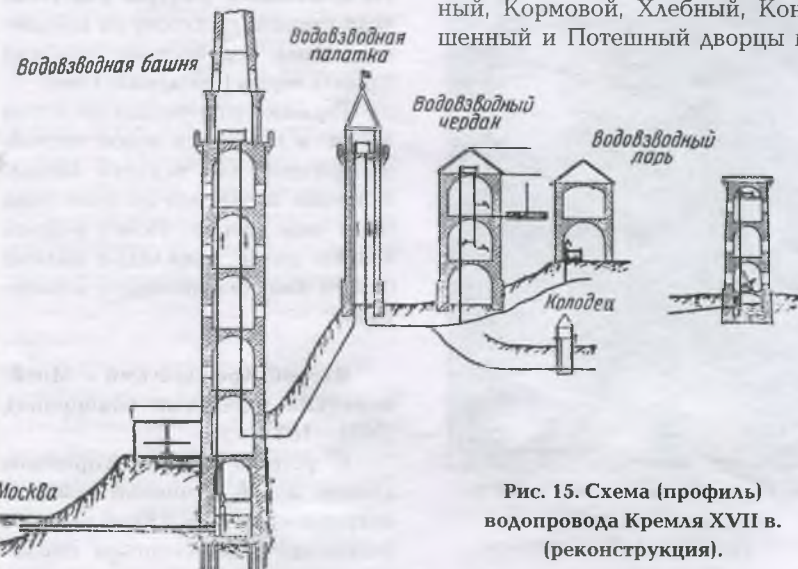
Схема (профиль) водопровода Кремля XVII в. (реконструкция).
